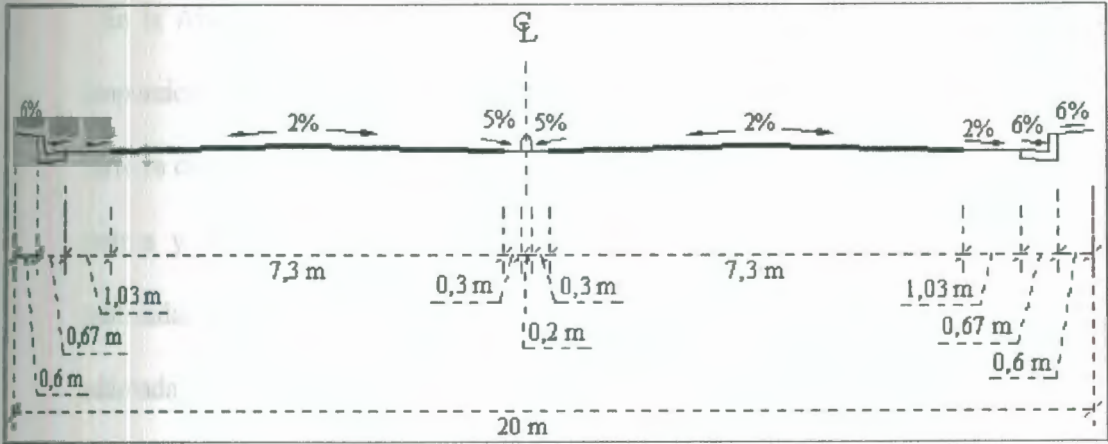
ALTERNATIVA DE SECCIÓN TIPO # 3
